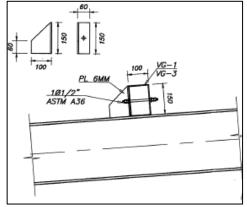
Se observa el perfil longitudinal rectangular modificada, en remplazo del perfil en l.
